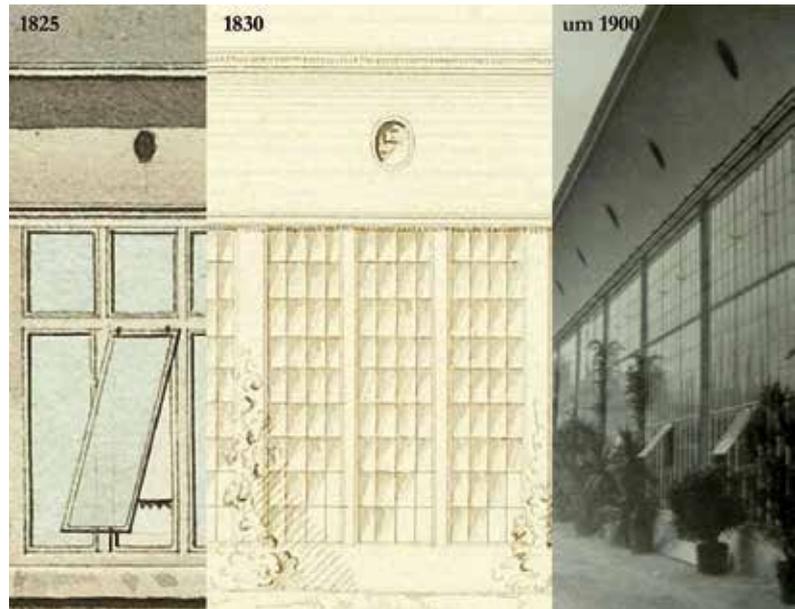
Orangerie, Fensterelemente im Vergleich, 1825 – 1830 – um 1900 (Fotomontage 2021, Sebastian Väth, BSV, Gärtenabteilung, Plan- und Fotogrundlagen: siehe Abb. 4 und 5)
